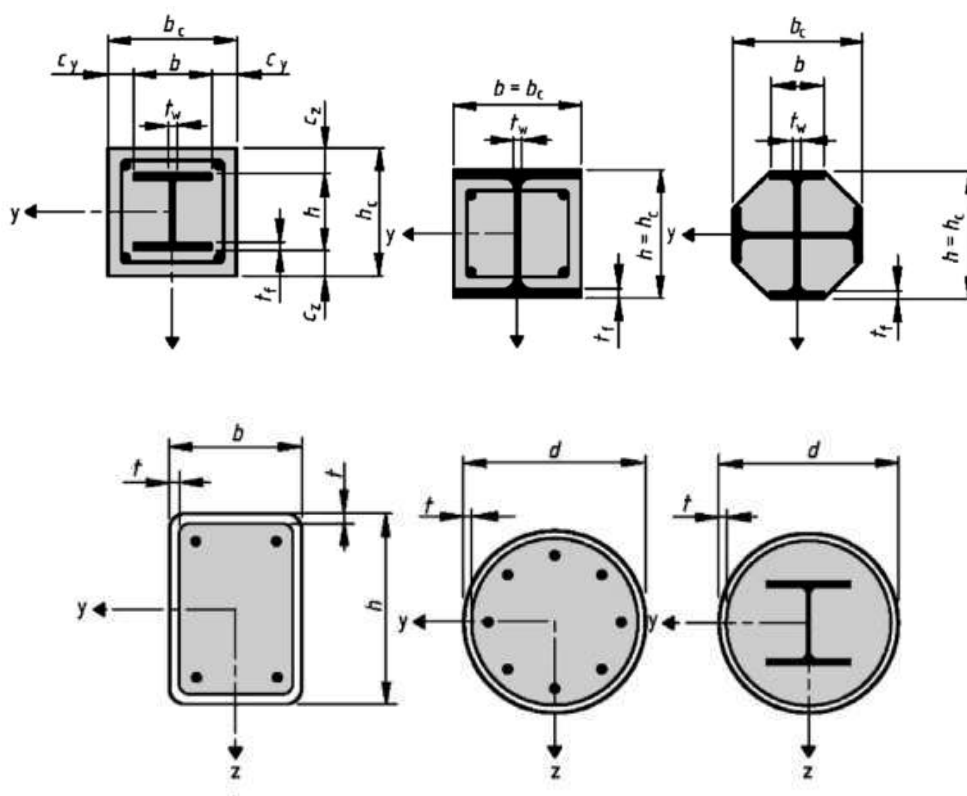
Наиболее распространенные типы сечений сталежелезобетонных колонн
